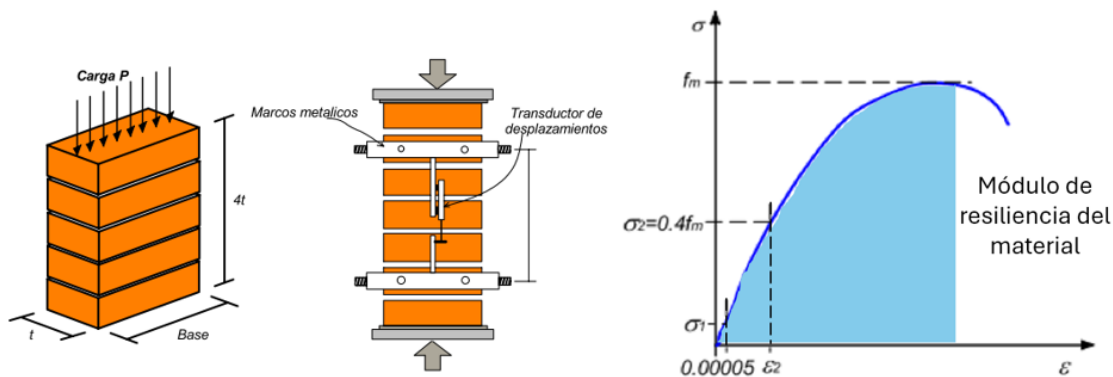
Pila para prueba en compresión de la mampostería (Zúñiga Cuevas, 2005)
